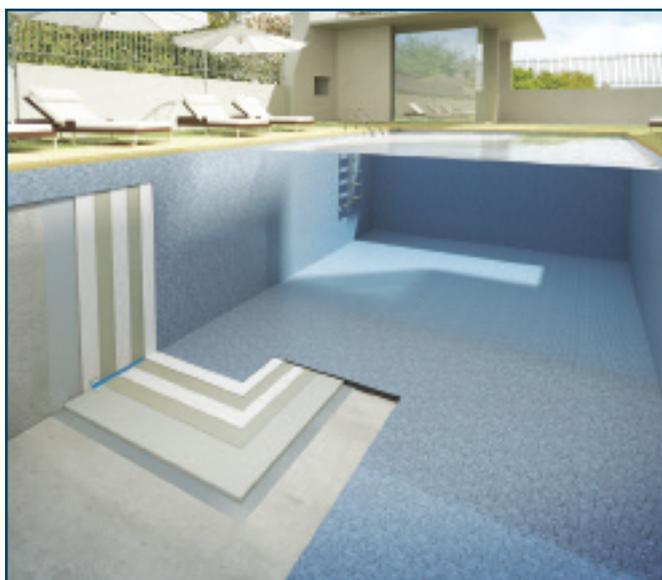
Colagem em zonas húmidas ou permanentemente submersas
